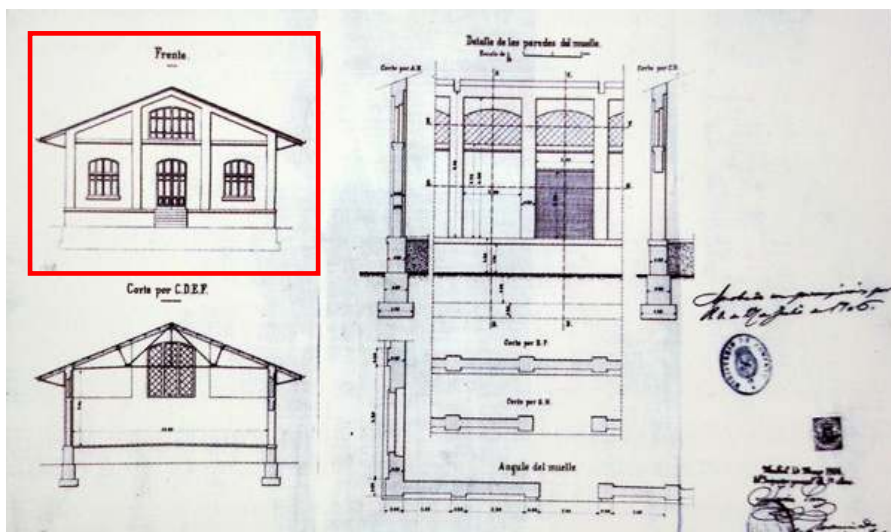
Alzado-sección y detalles cerramiento. Fotografía del proyecto original. FFE. A. Propio (2007).
